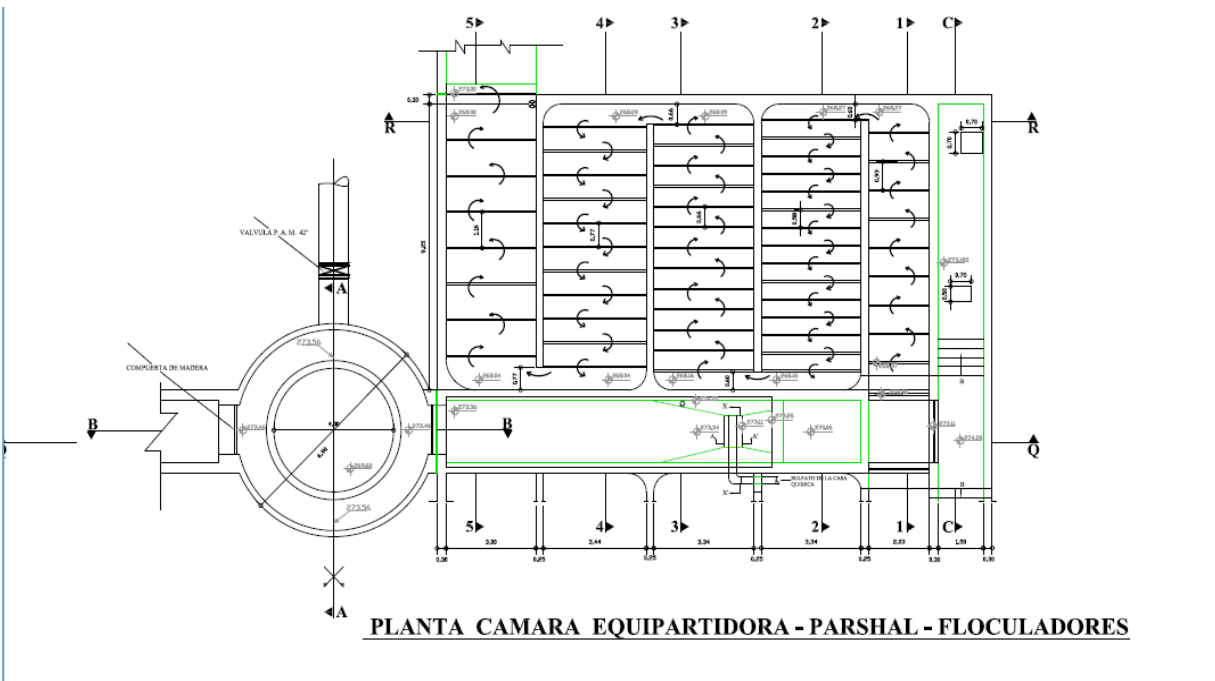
Planta de detalles de la cámara equipartidora, Parshall y alimentación a los módulos de tratamiento
